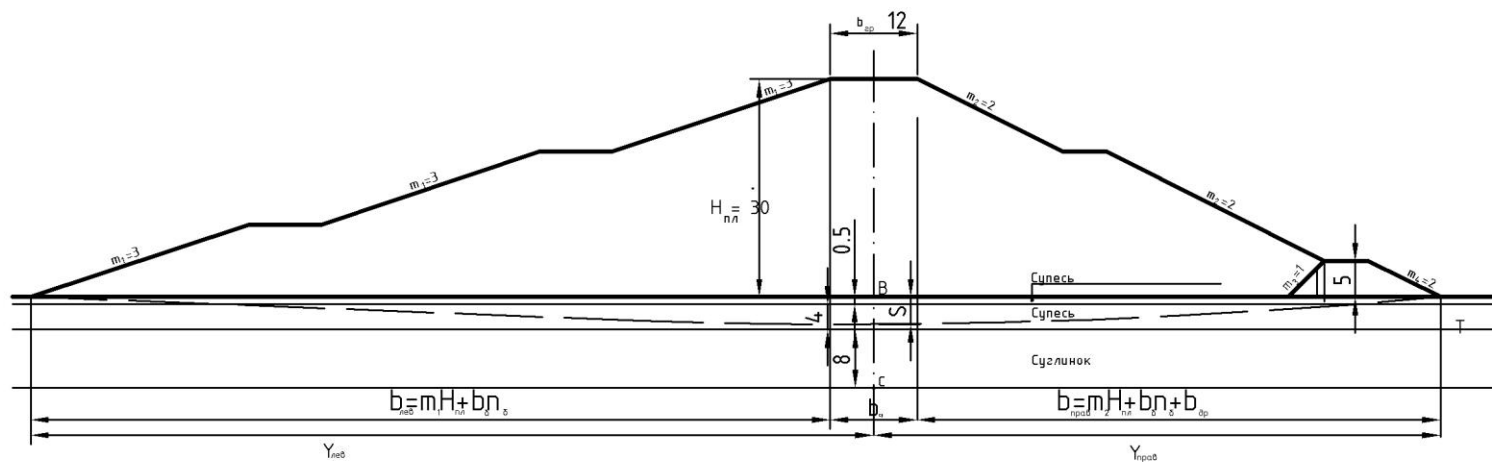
Расчетная схема осадки грунтов основания. М 1:1000
